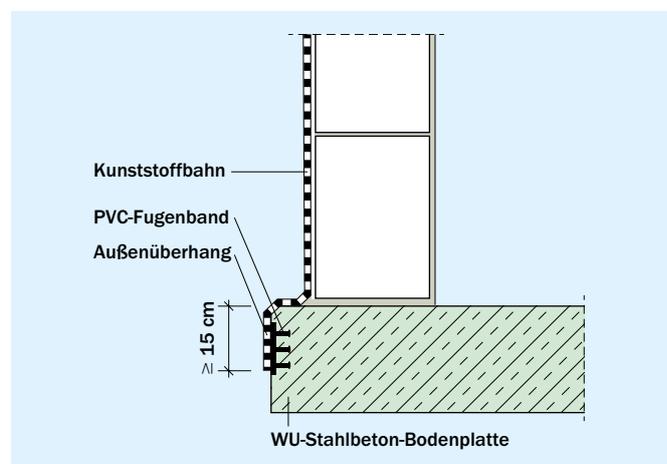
Übergang einer Abdichtung aus Kunststoffbahnen auf die Stirnfläche einer Betonbodenplatte mit Einbauteilen, z.B. mit in die Bodenplatte einbetonierten, außenliegenden und mit der Abdichtung kompatiblen Fugenbändern.
